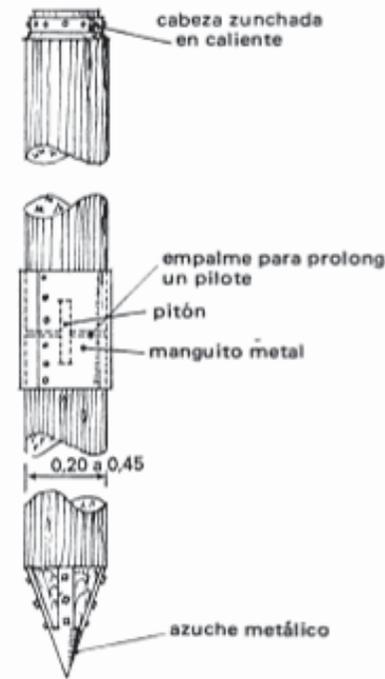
detalle pilote de madera. Enciclopedia de la construcción.
